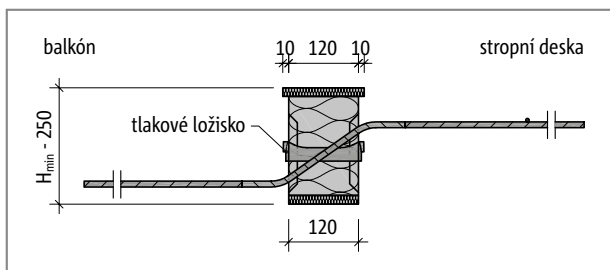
Schöck Isokorb® typ QXT10: Půdorys prvku
